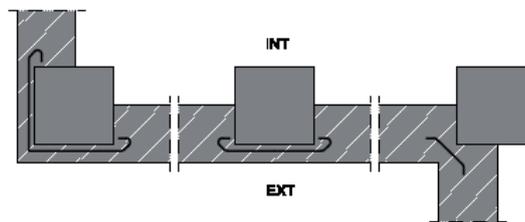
Ejemplo de encuentro de la fachada con los pilares
